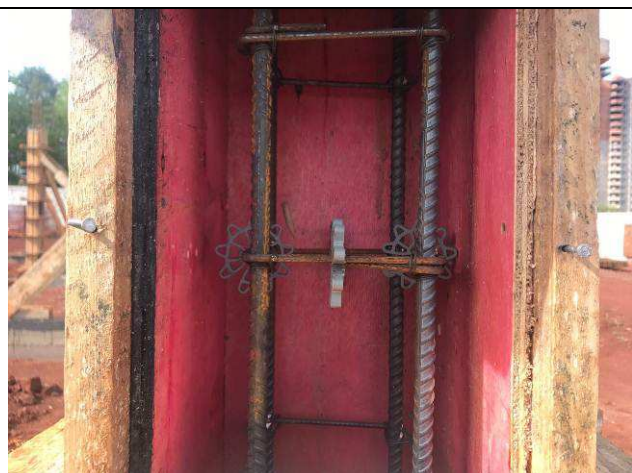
C: Formas e armaduras do pilar P78 do prédio principal.
